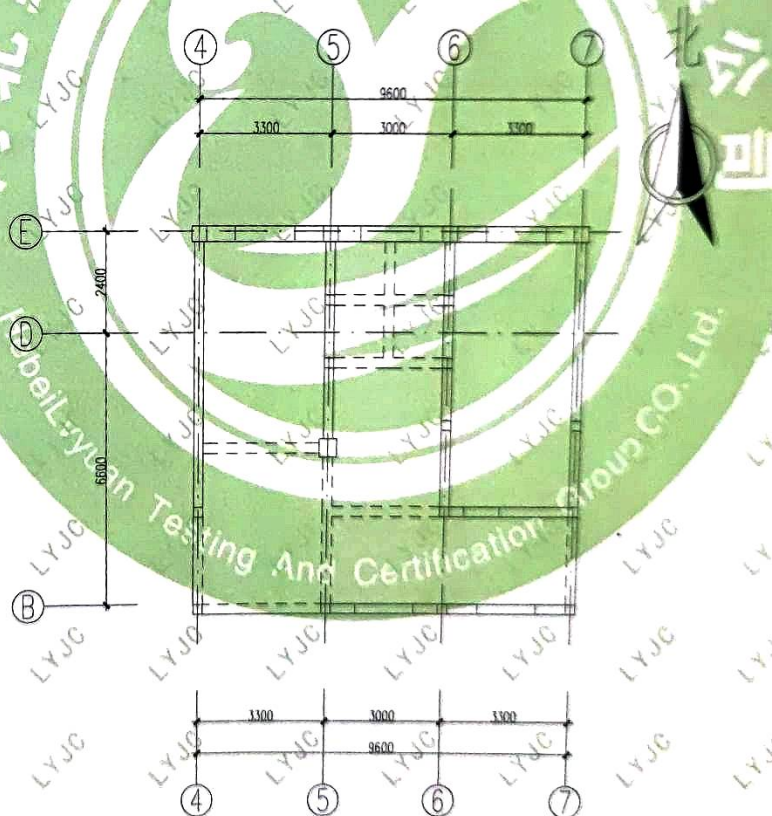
局部六层现结构平面布置示意图 (单位: mm)
